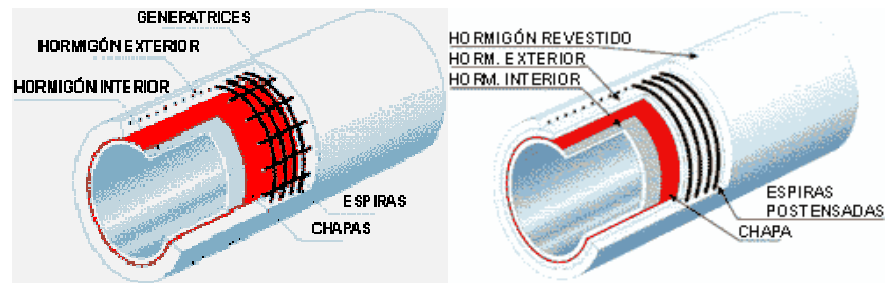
TUBERÍAS DE CONCRETO ARMADO Y POSTENSADO CON CAMISA DE CHAPA.
